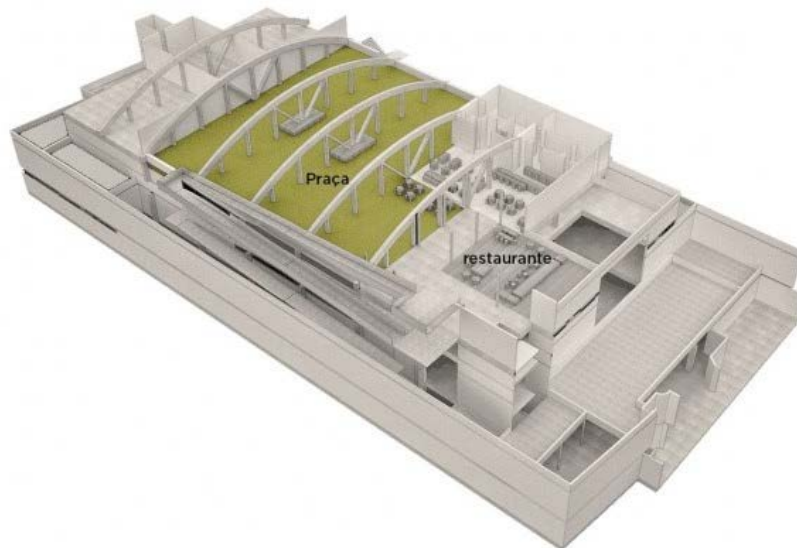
Projeto do 1º Pavimento do Centro Cultural João Nogueira
